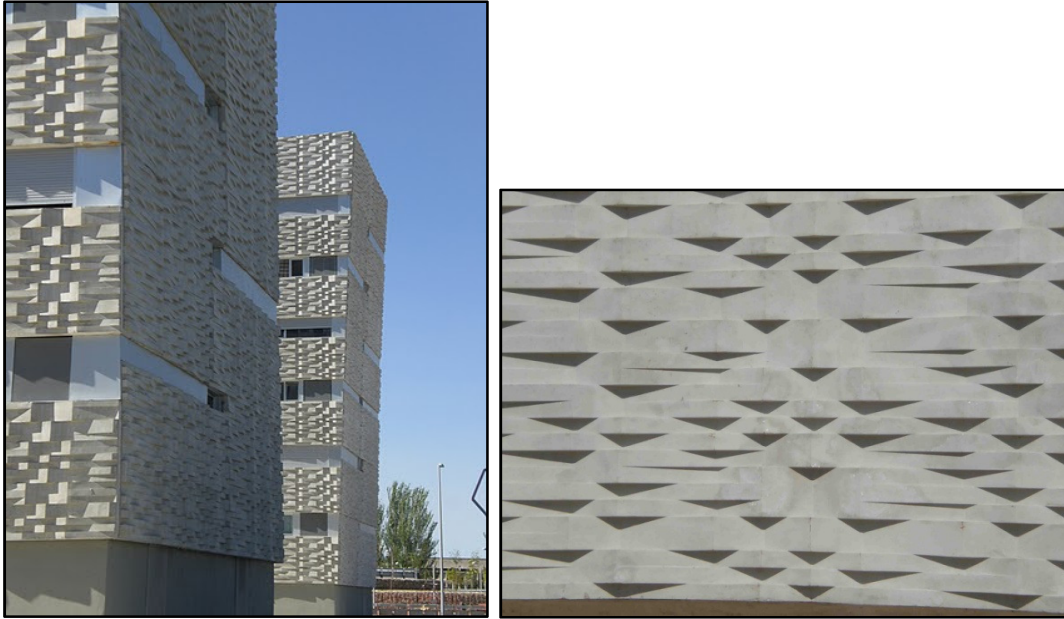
y 2.5. Acabados de la fachada de hormigón pintado de la biblioteca de la universidad de Utrech.
